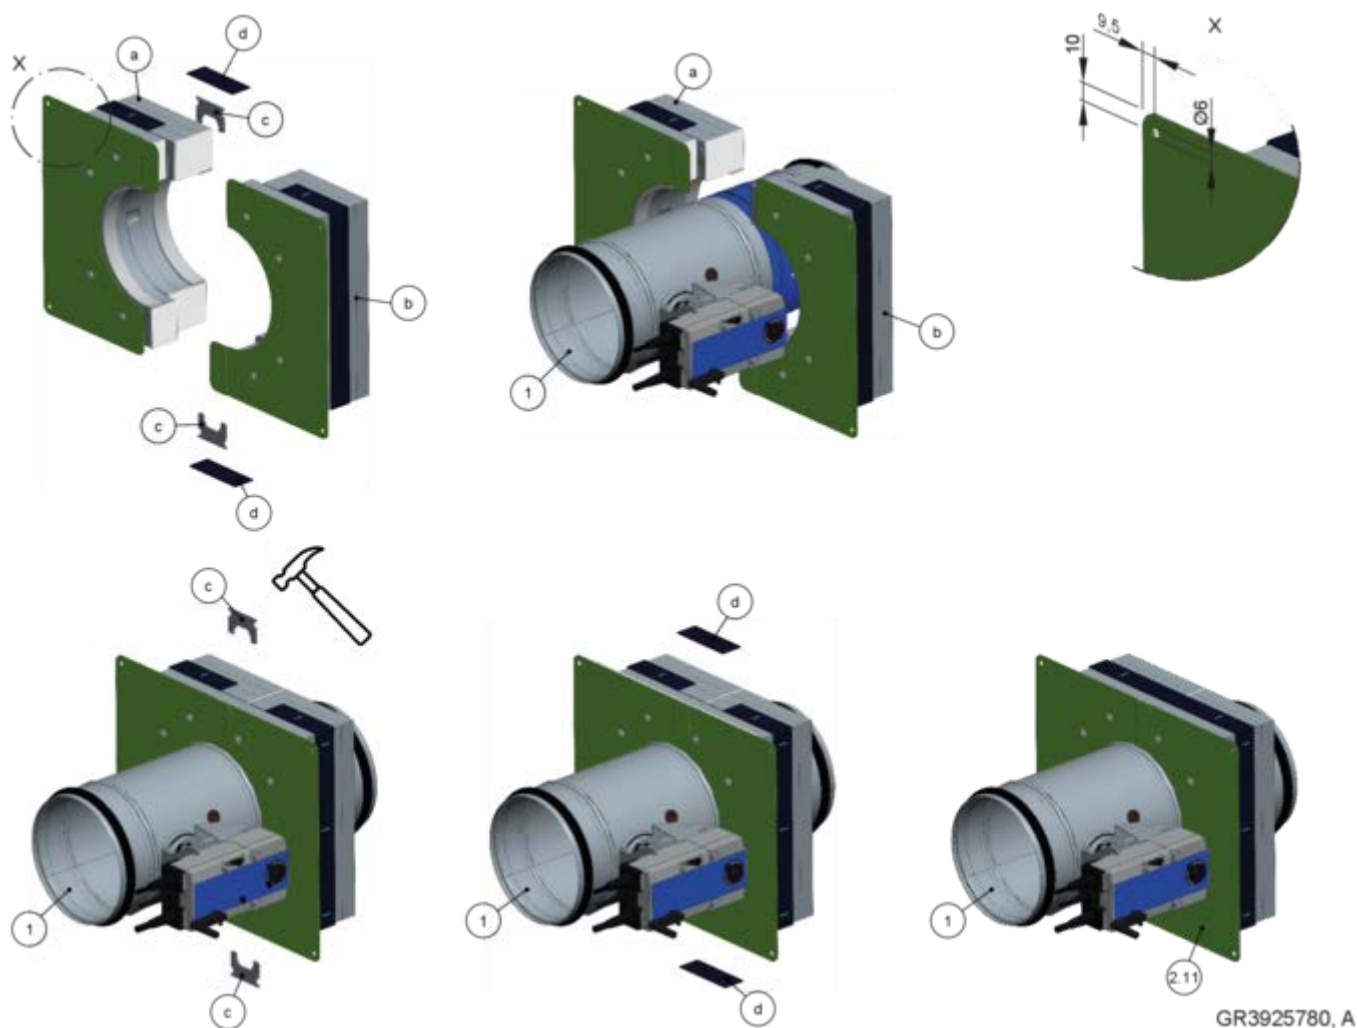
Leveranspaket och installation av installationskit TQ2 för torr installation utan murbruk
